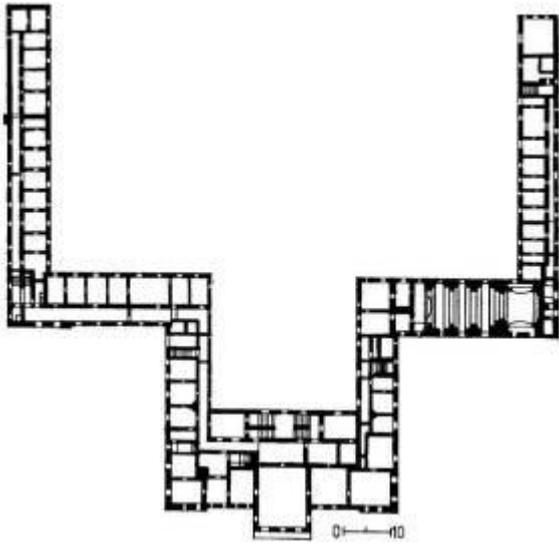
Schloss Grassalkovich in Gödöllő, Grundriss (OG)
